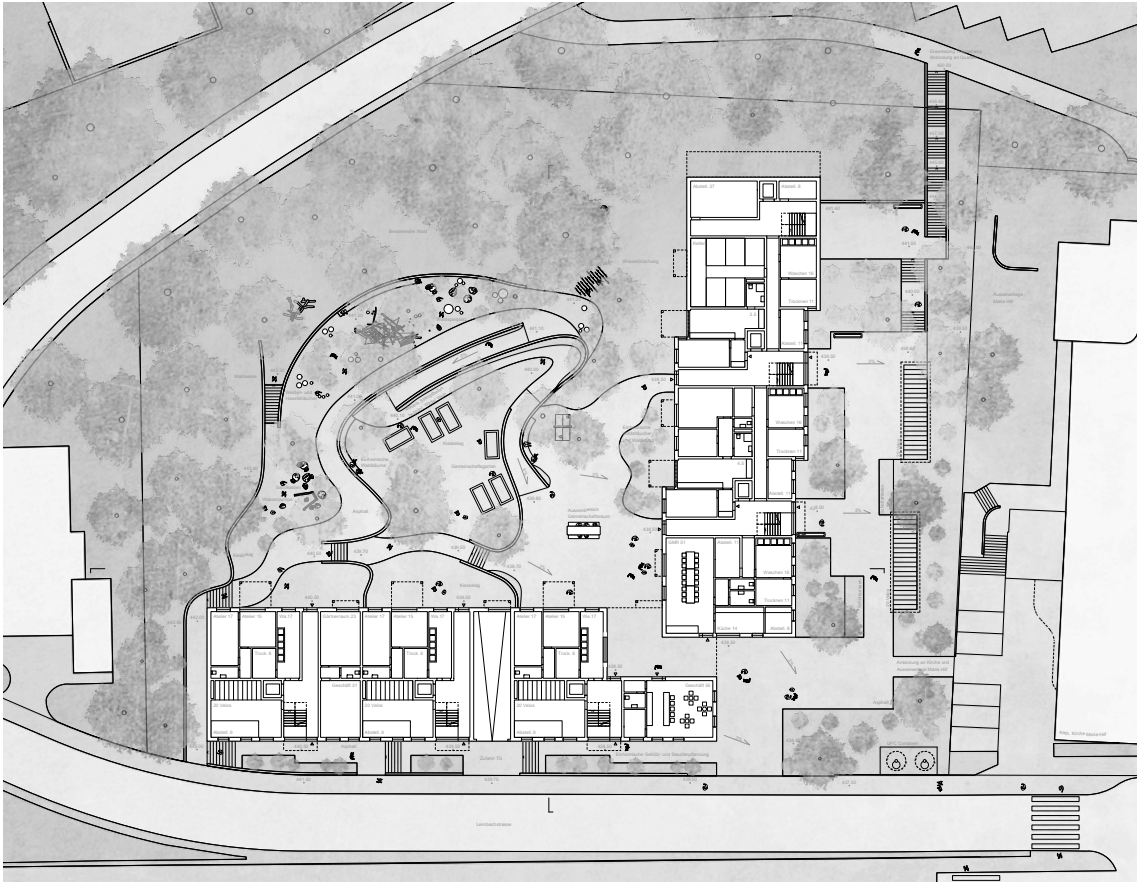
Waldarena: Erdgeschoss mit Umgebung
